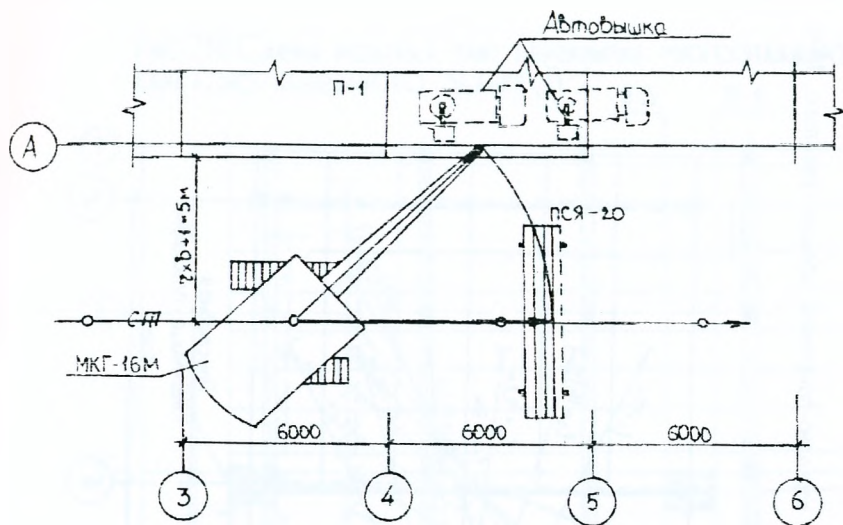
Схема монтажа стеновых панелей поворотом стрелы крана.
